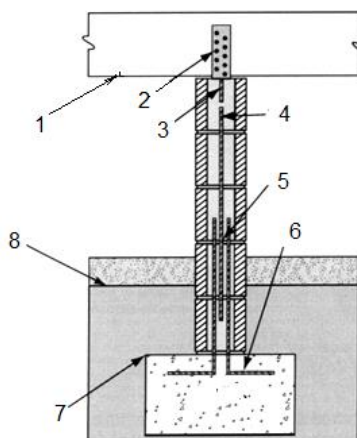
Вертикальное армирование стен с пилястрами из пустотных бетонных блоков [8]
